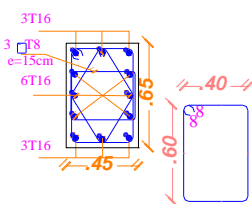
DETAIL DE COFFRAGE ET FERRAILLAGE DE POTEAU TYPE: 09
